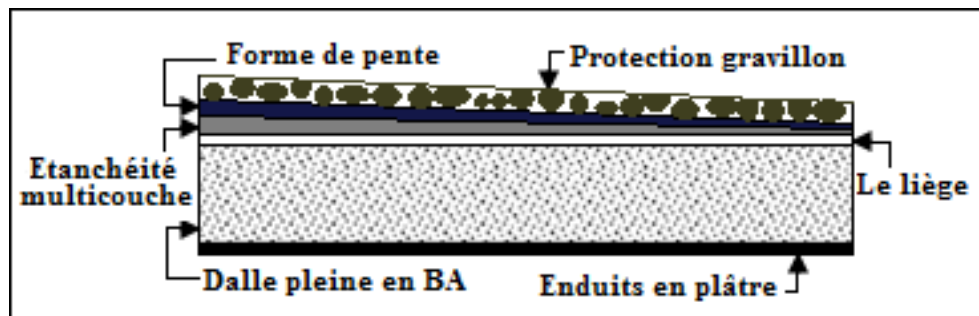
Plancher Dalle pleine Terrasse inaccessible
